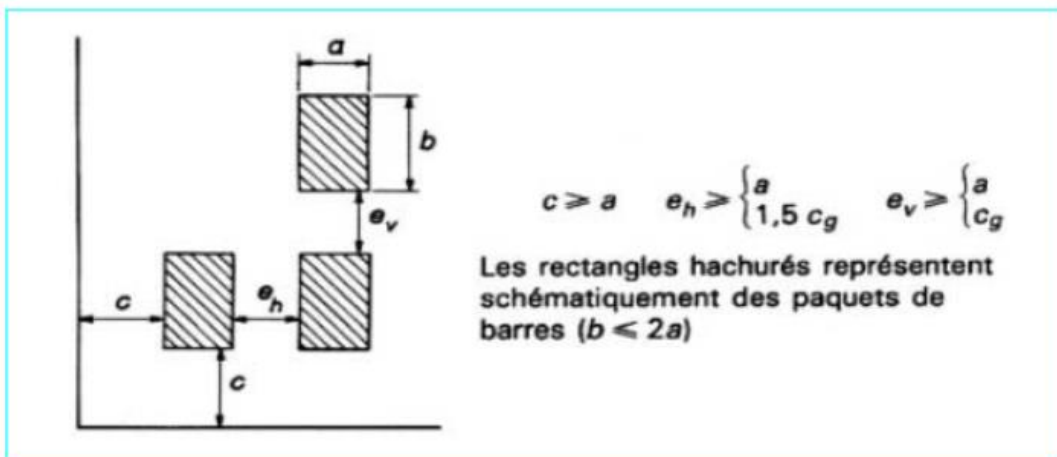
Enrobages et distances minimales entre barres ou paquets de barres
